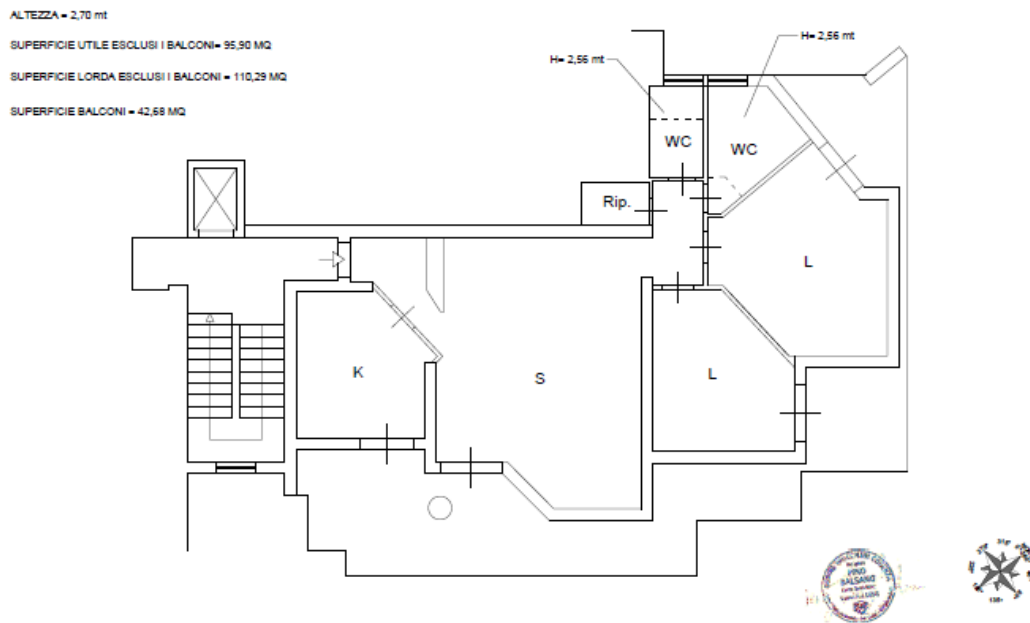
PLANIMETRIA RILEVATE STATO ATTUALE ( in allegato)
